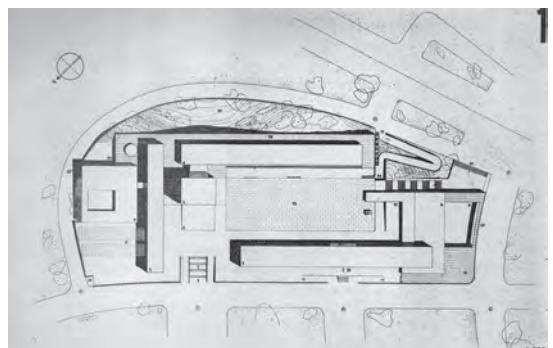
Bottino, Mucci, Pucci. Progetto per la piazza delle Forze armate all’E42, 1937. Planimetria generale. Milano, APB.
